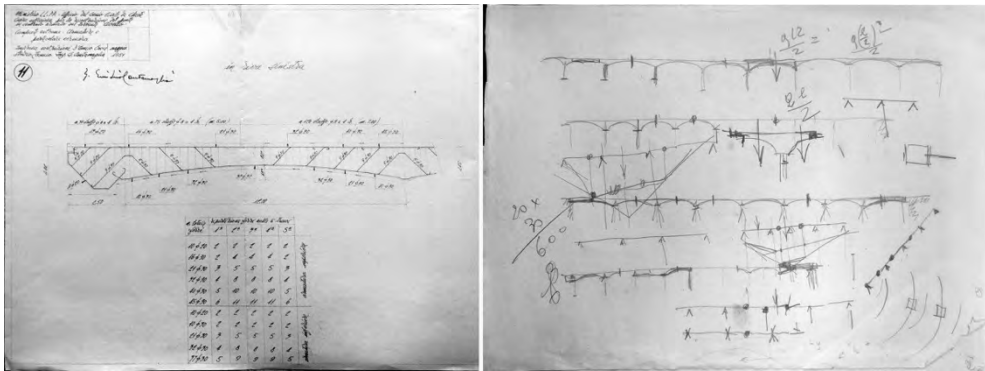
Ing. G. Cantamaglia: ponte sull’Avello, armature delle campate estreme, scala 1:50 e tabella delle sezioni dei ferri (a sinistra); schizzi di studio dei carichi ripartiti nei vari segmenti delle campate (a destra).
